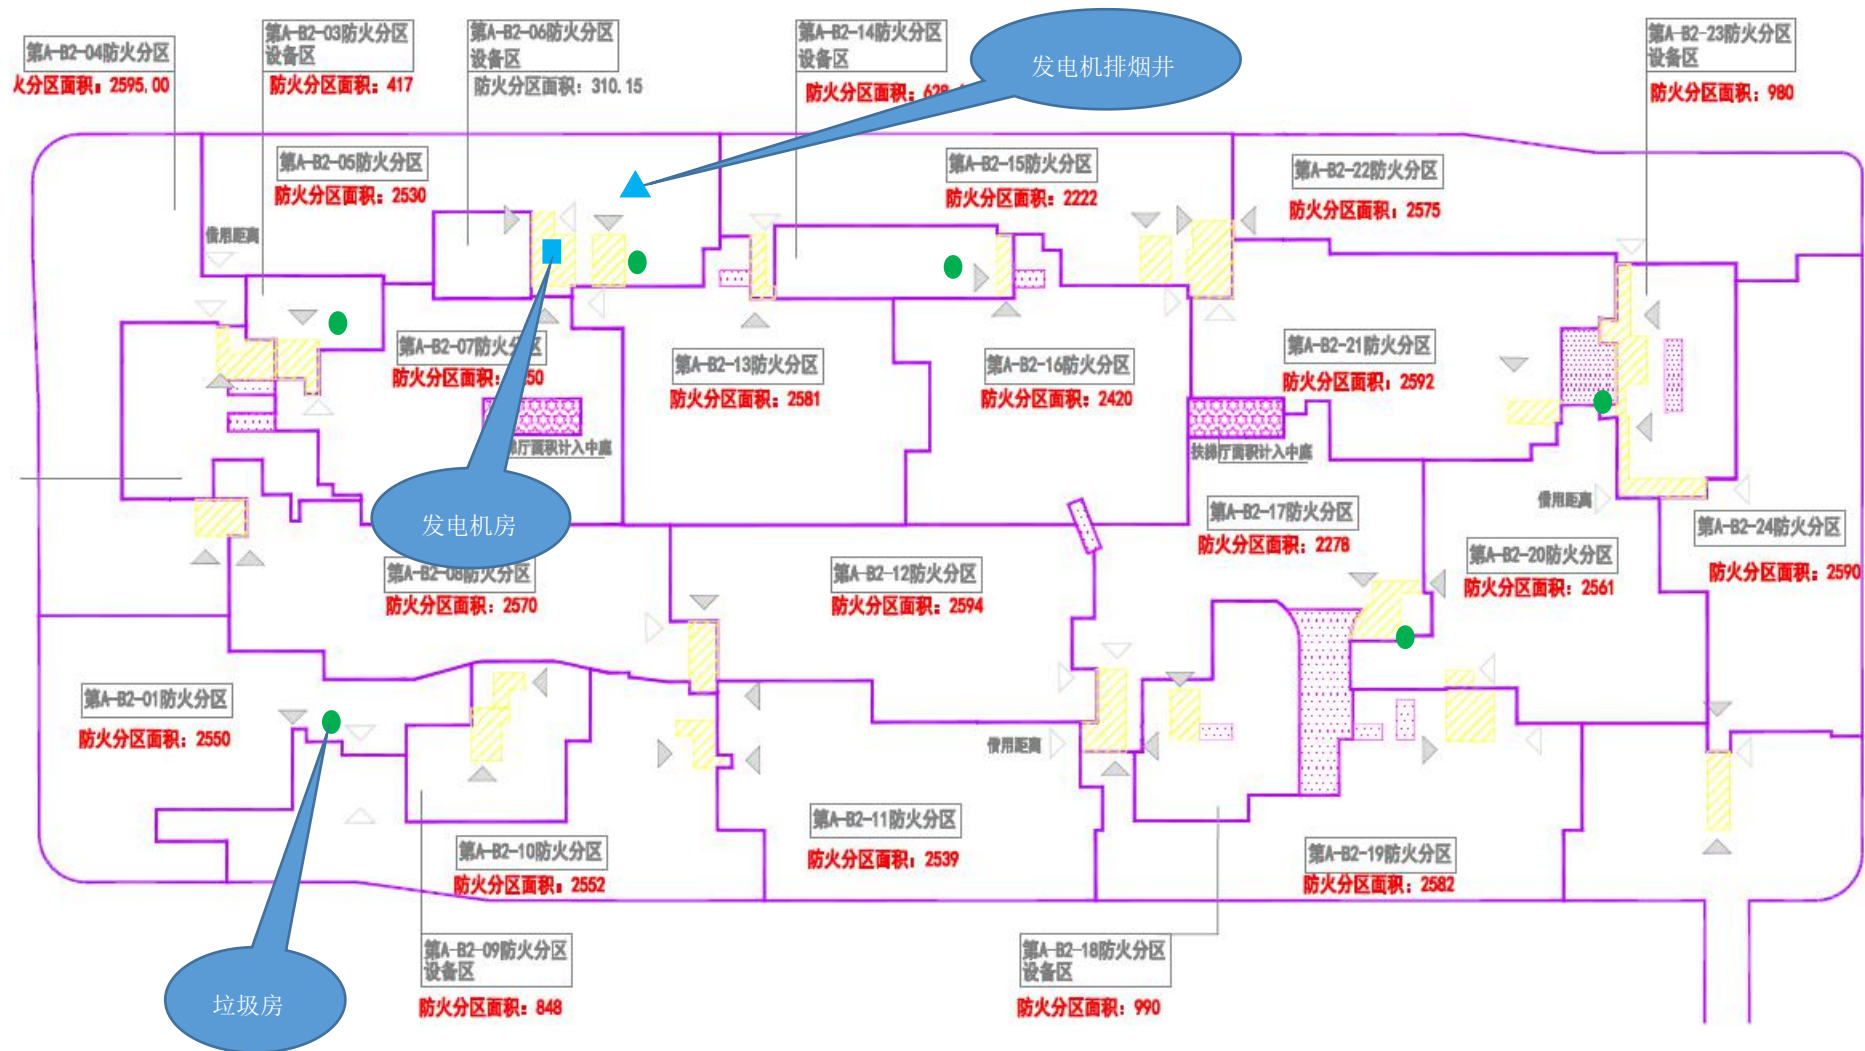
A地块地下二三层平面图（垃圾房、发电机房位置）
